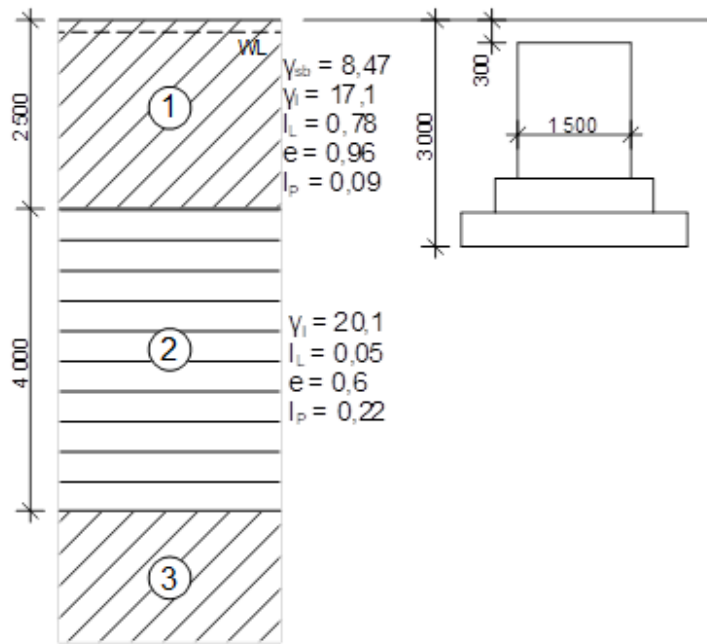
Схема розміщення фундаменту у ґрунті
